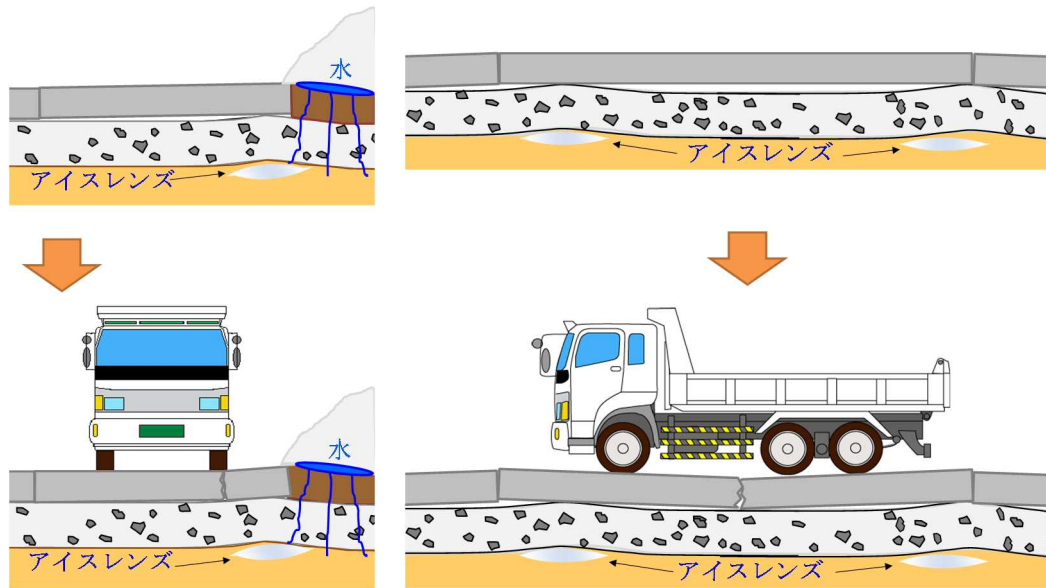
凍上に起因するひび割れ発生メカニズム
